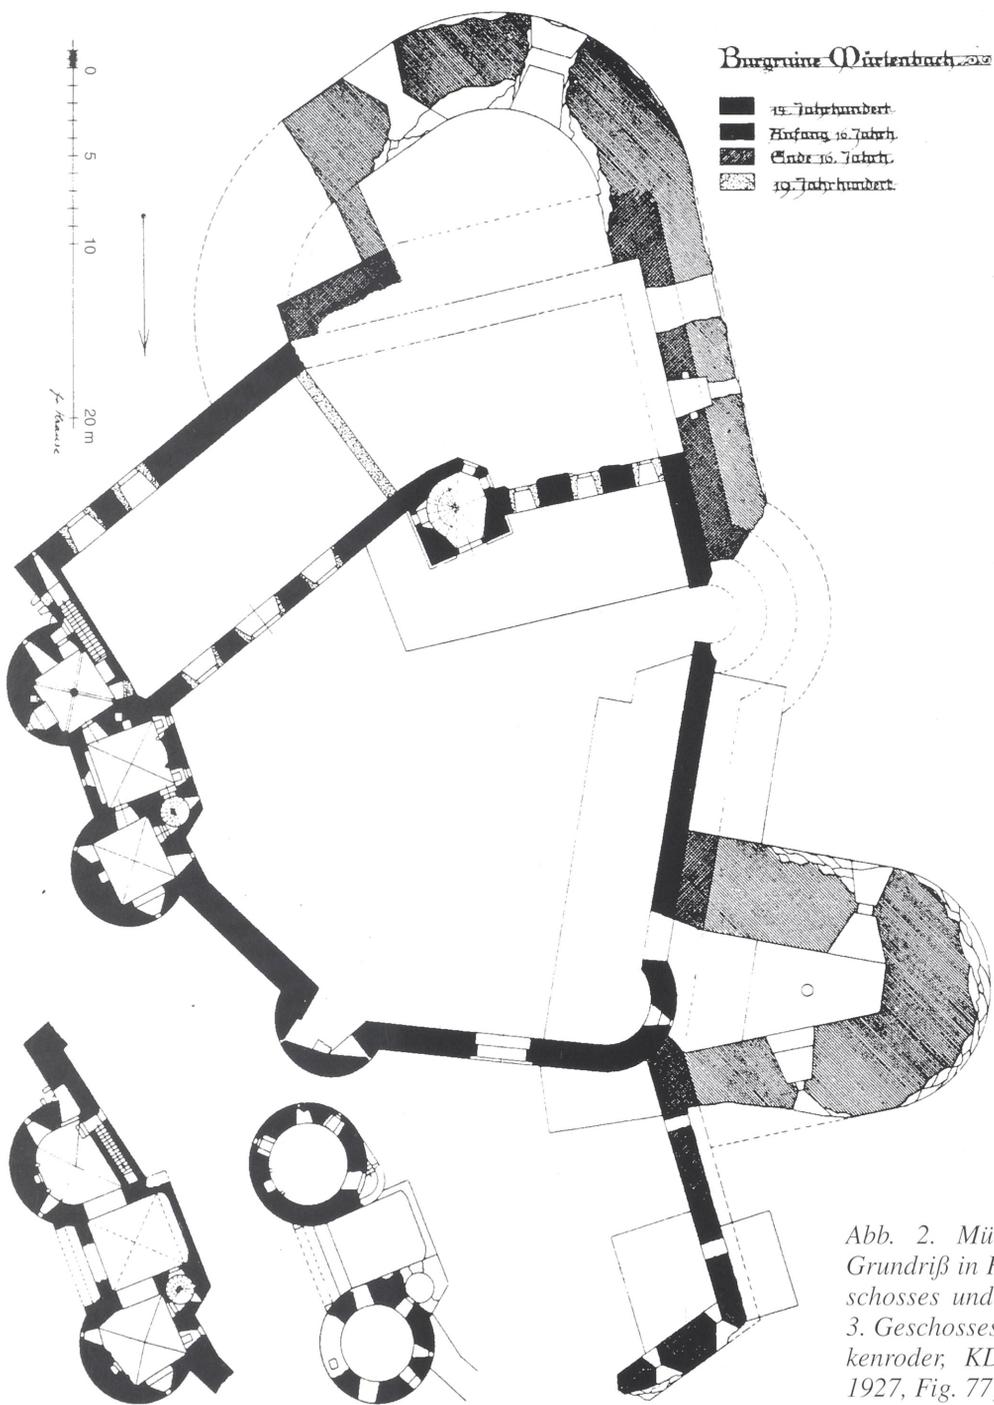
Mürlenbach, Betradaburg. Grundriß in Höhe des ersten Obergeschosses und Grundrisse des 2. und 3. Geschosses des Torbaus (aus: Wakkenroder; KD-Inventar Kreis Prüm, 1927, Fig. 77).
